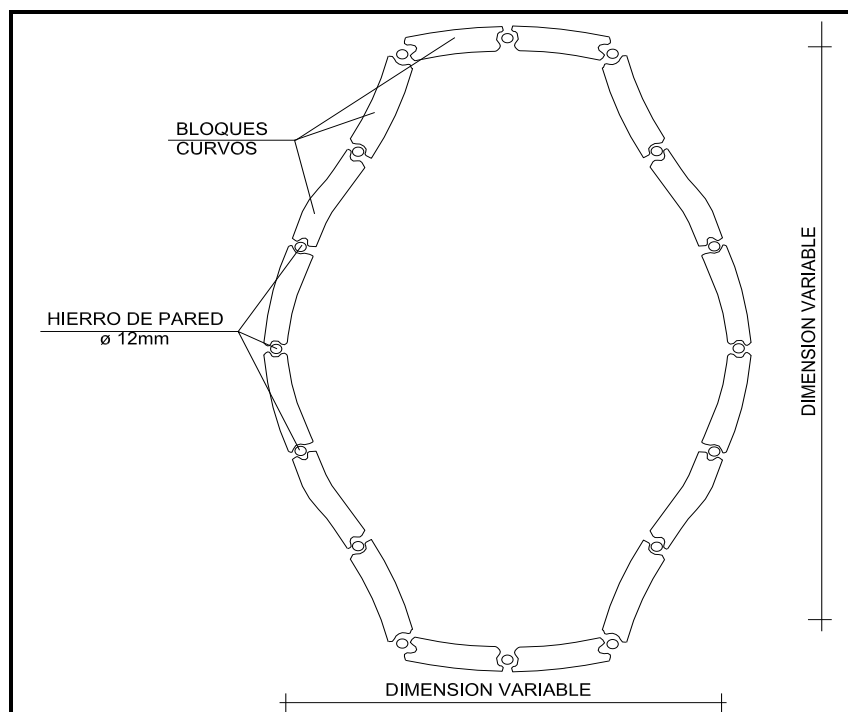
Detalle para la construcción de pozo de 80 bloques
